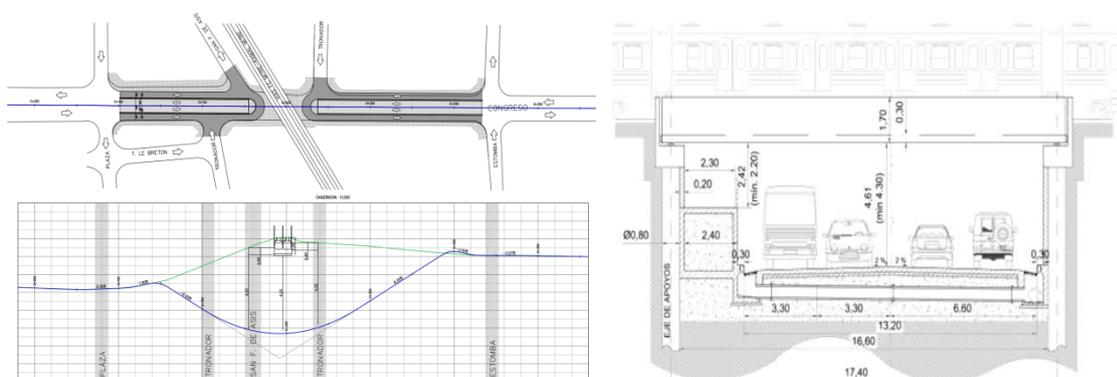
Planta y Cortes Longitudinales y Transversales típicos de un PBN.
